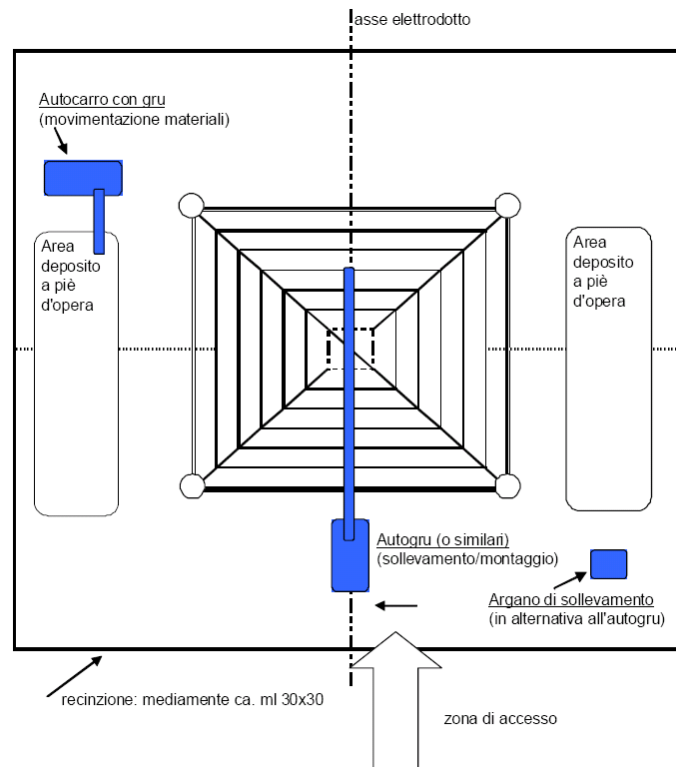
Planimetria dell'Area Sostegno (montaggio sostegno)
